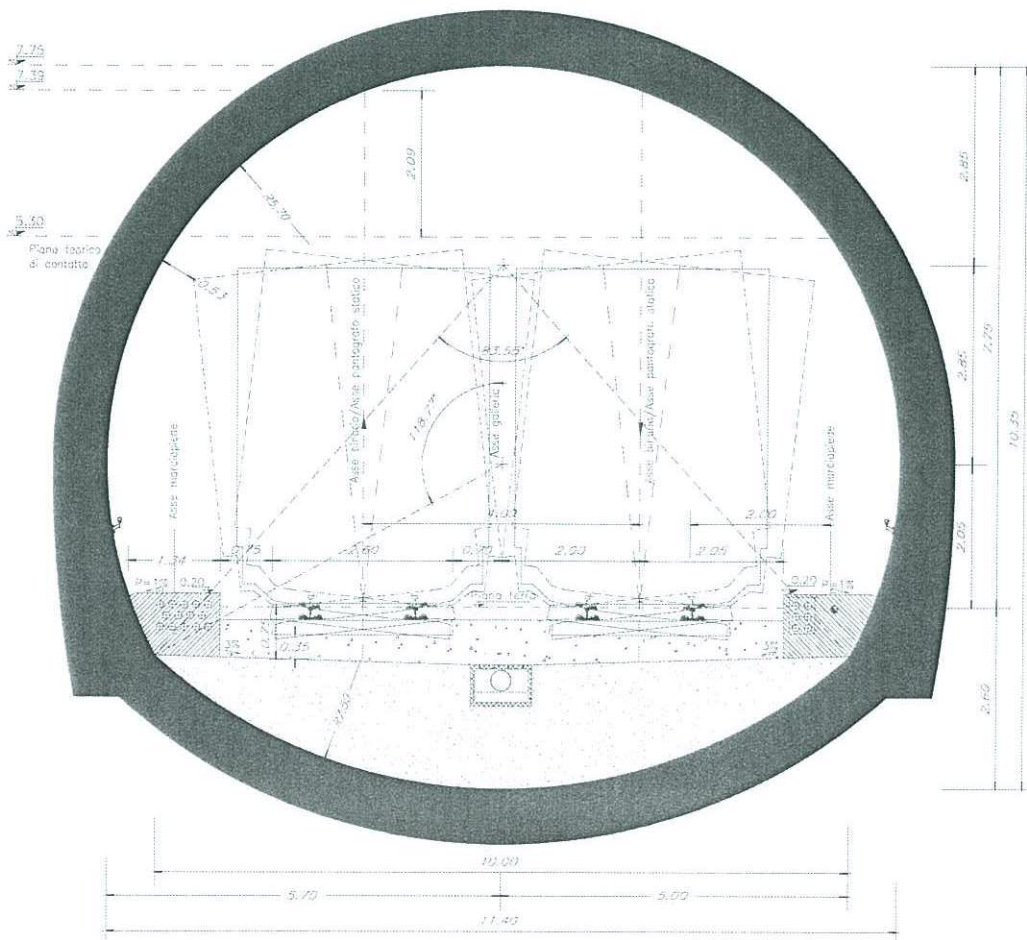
Sezione tipo di ntradosso galleria doppio binario scavo tradizionale
